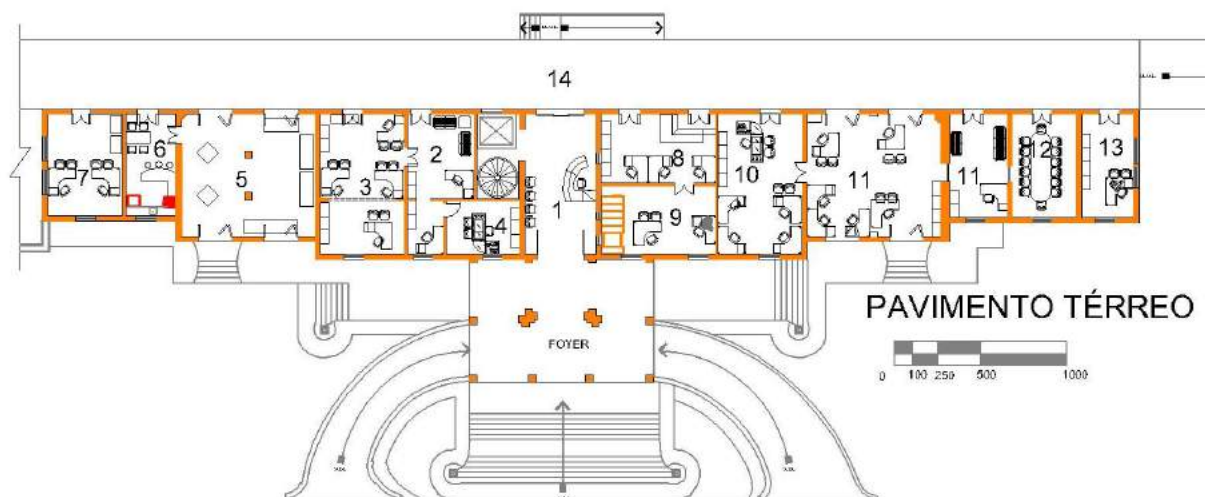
Planta do Pavimento Térreo da Estação da Goiás – Projeto de Restauração e Adequação da Estação da Goiás – Centro Administrativo de Araguari
